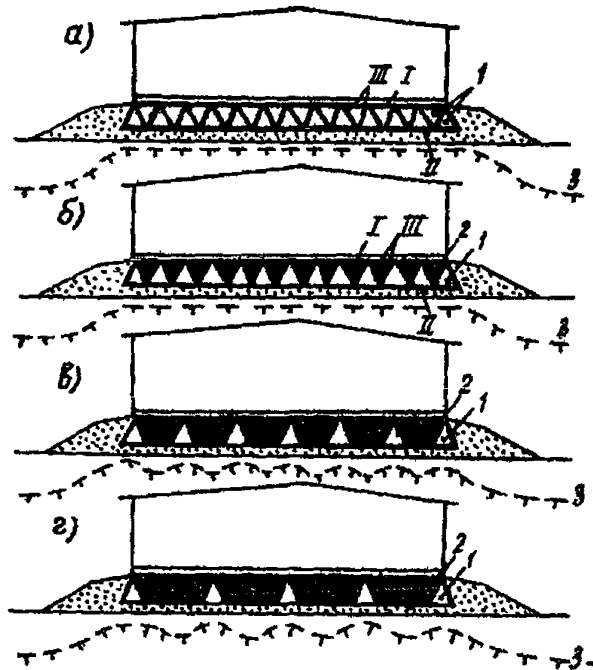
Рис. I. Схемы охлаждения грунтов оснований плитных фундаментов:
